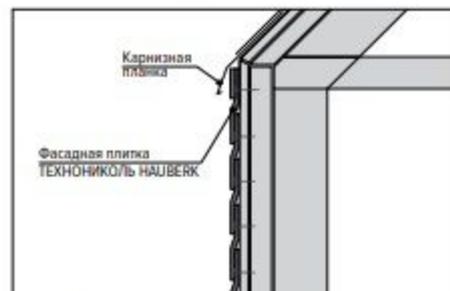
Монтаж верхнего ряда в домах без карнизного свеса
